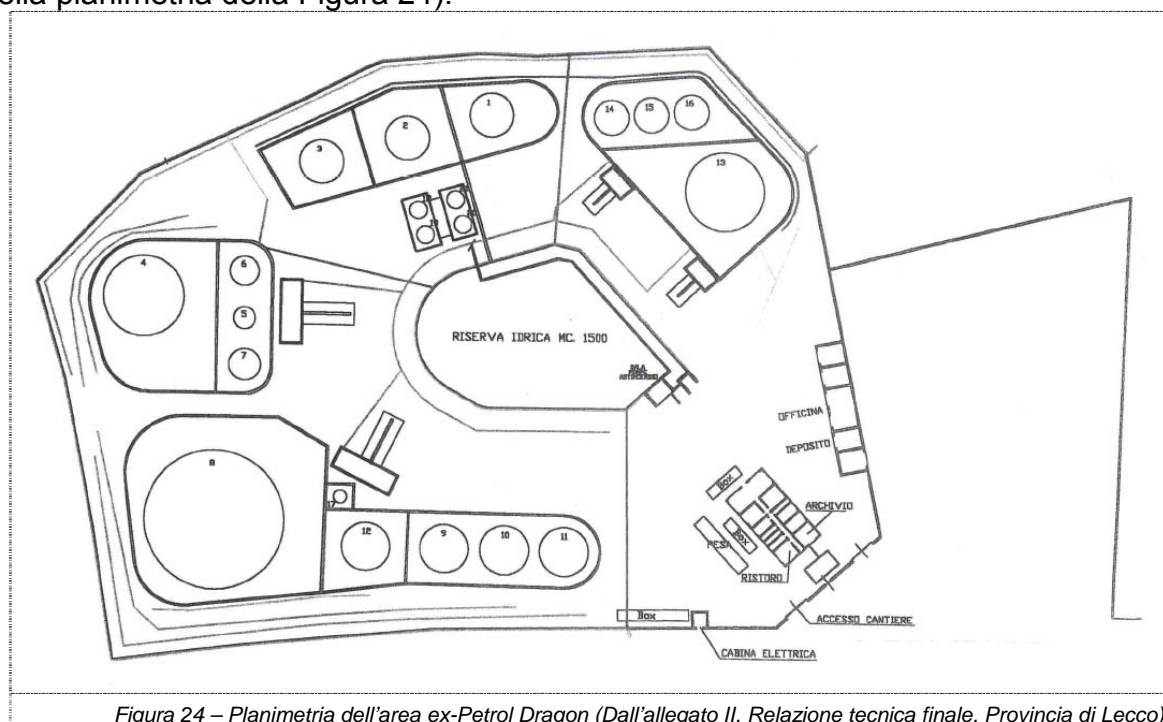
Planimetria dell'area ex-Petrol Dragon (Dall'allegato II, Relazione tecnica finale, Provincia di Lecco)
